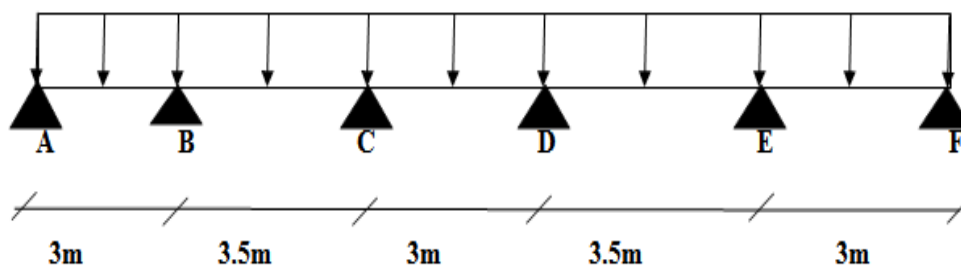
schéma statique de la poutre reposant sur six appuis.
